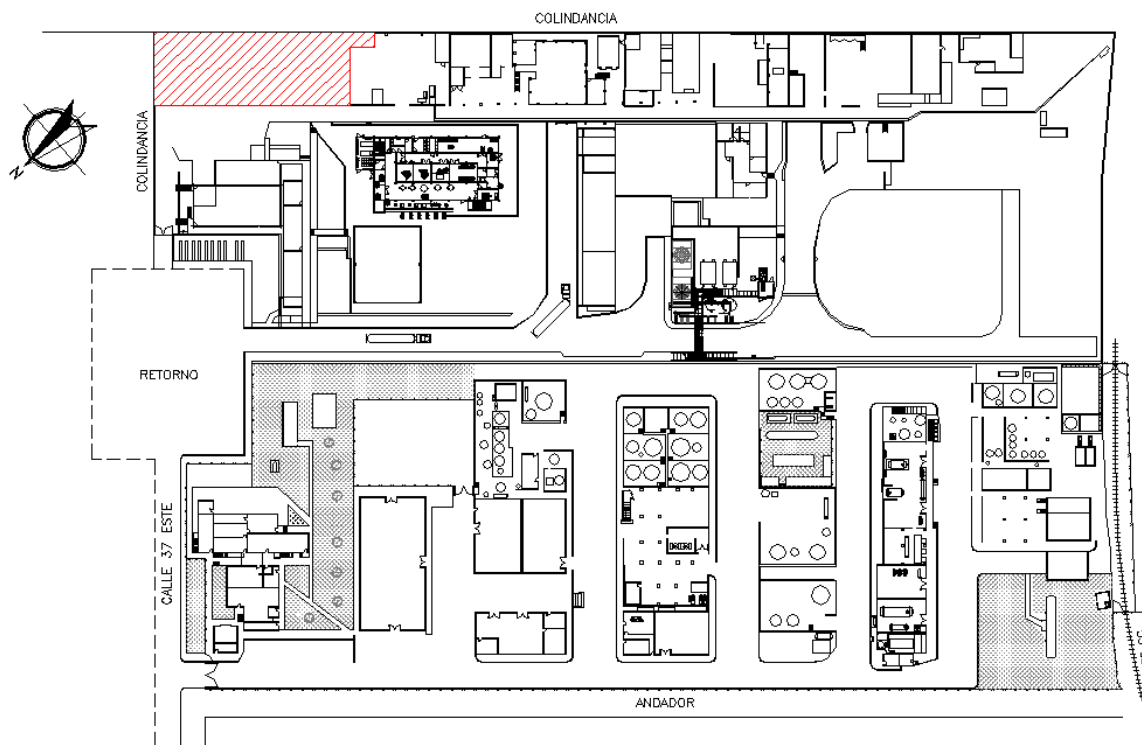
Croquis de Conjunto. Localización de terreno destinado al proyecto ubicado en la esquina oriente de la Planta Industrial. Proporcionado por el cliente.
